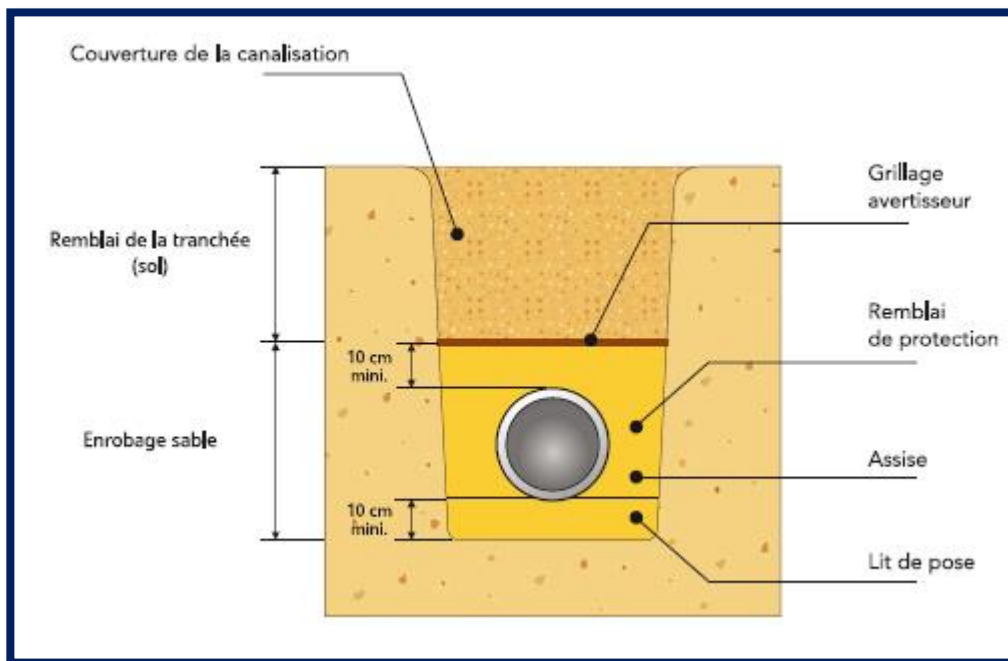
Vue général sur la tranchée (B E H A U ;2018)
